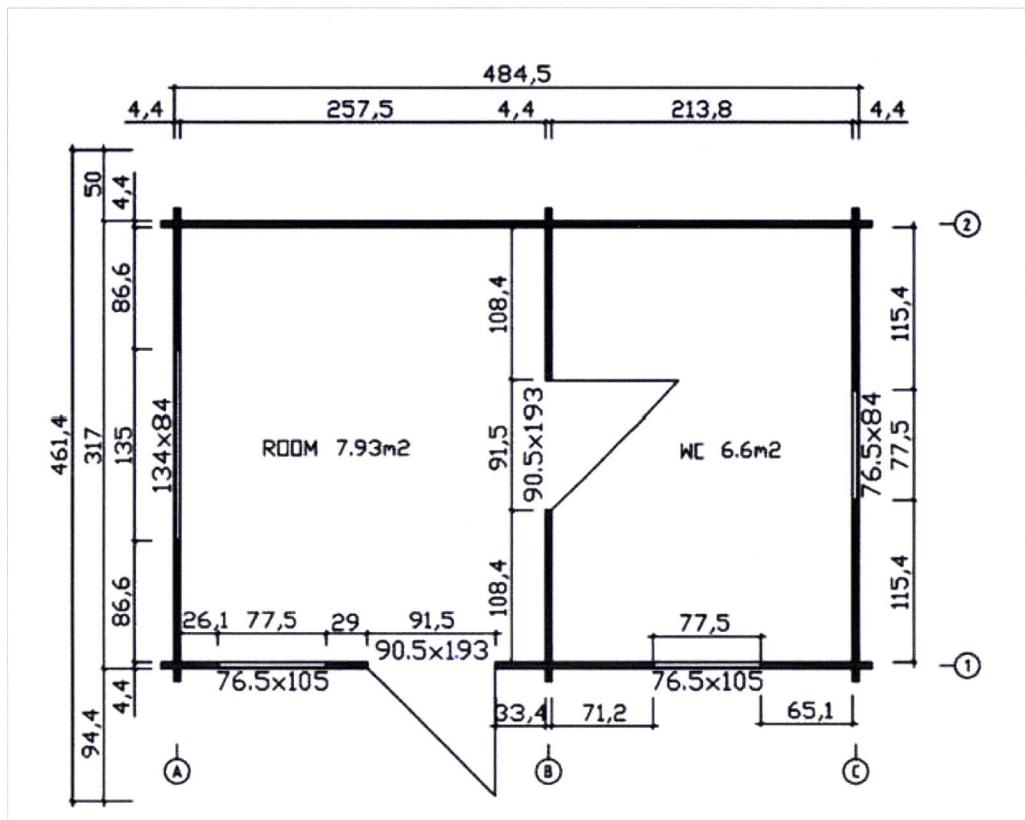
Planta da Casa de Apoio (Área bruta: 15m<sup>2</sup>)
